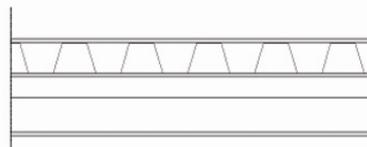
/4 INCASTRO TRAVE-COLONNA (Passante)
